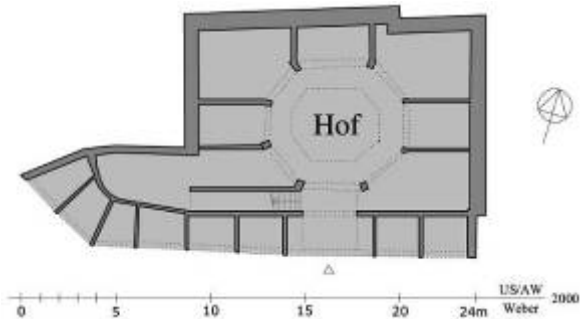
Wakālat al-ʿAššā, Grundriss EG
